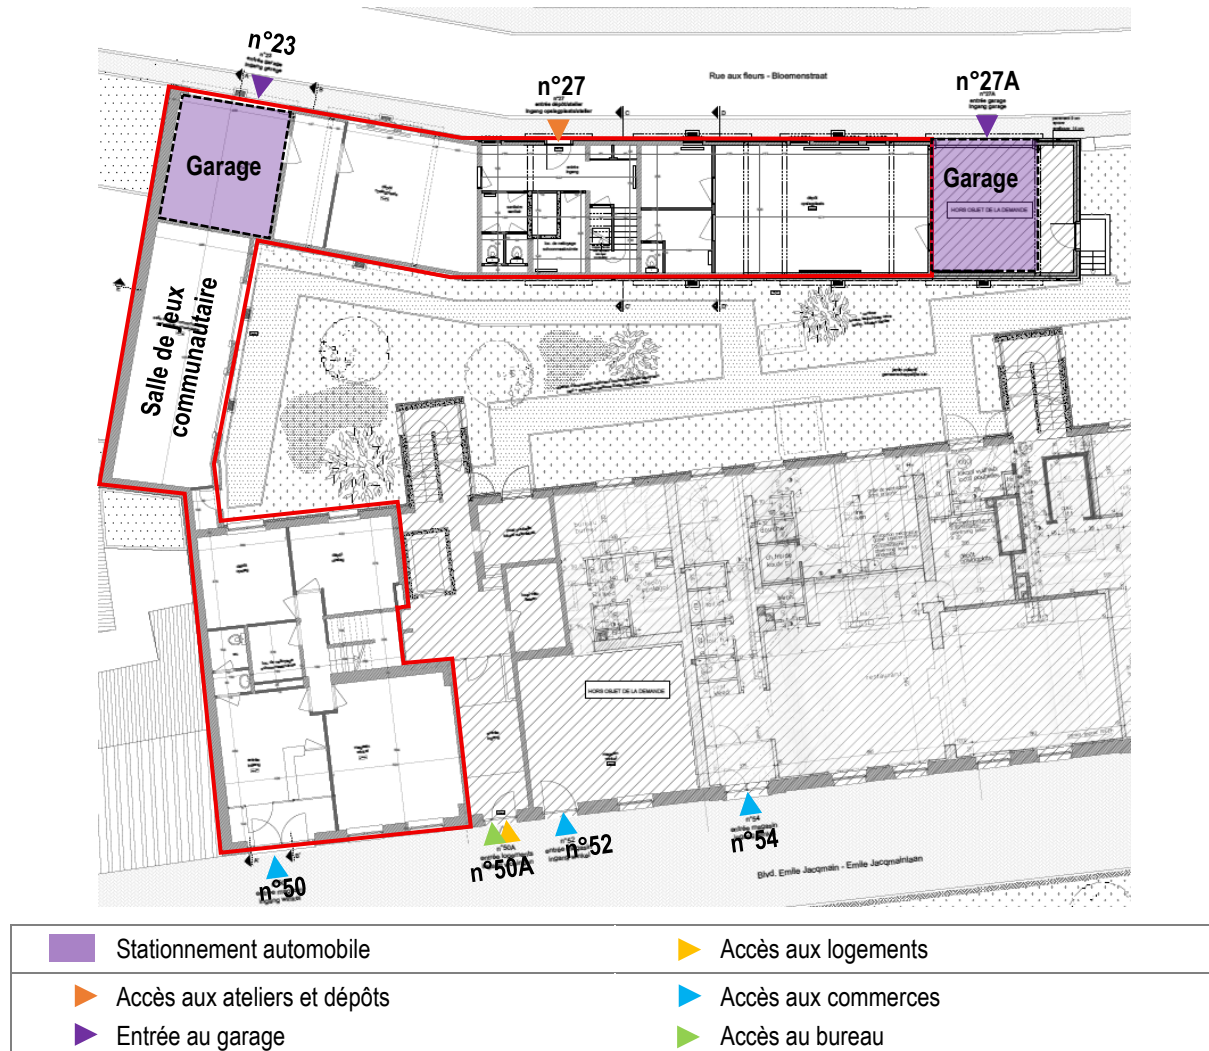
Localisation des accès aux bâtiments et zones de stationnement en situation existante (ARIES sur fond Ville de Bruxelles, 2025)
